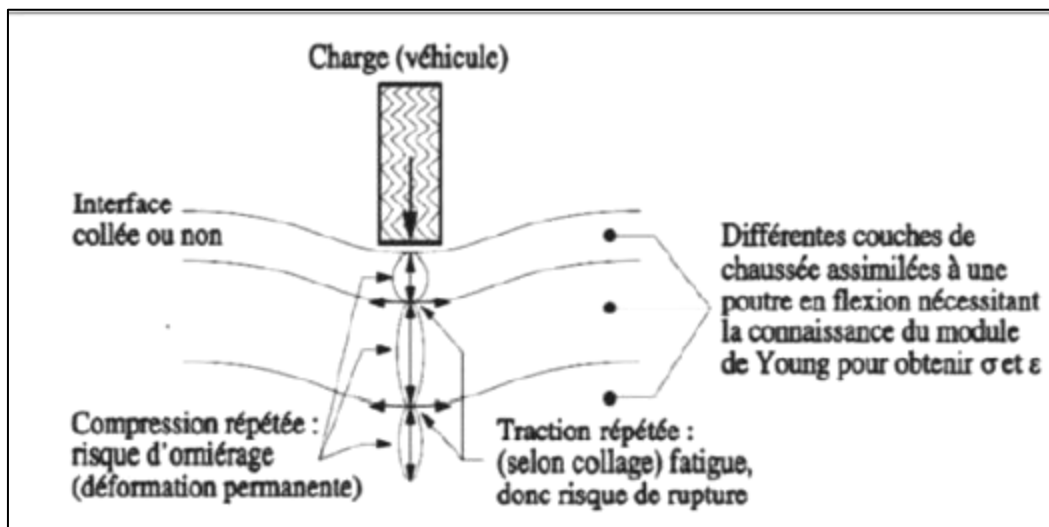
Sollicitations mécaniques induites par le trafic dans la structure de chaussée
